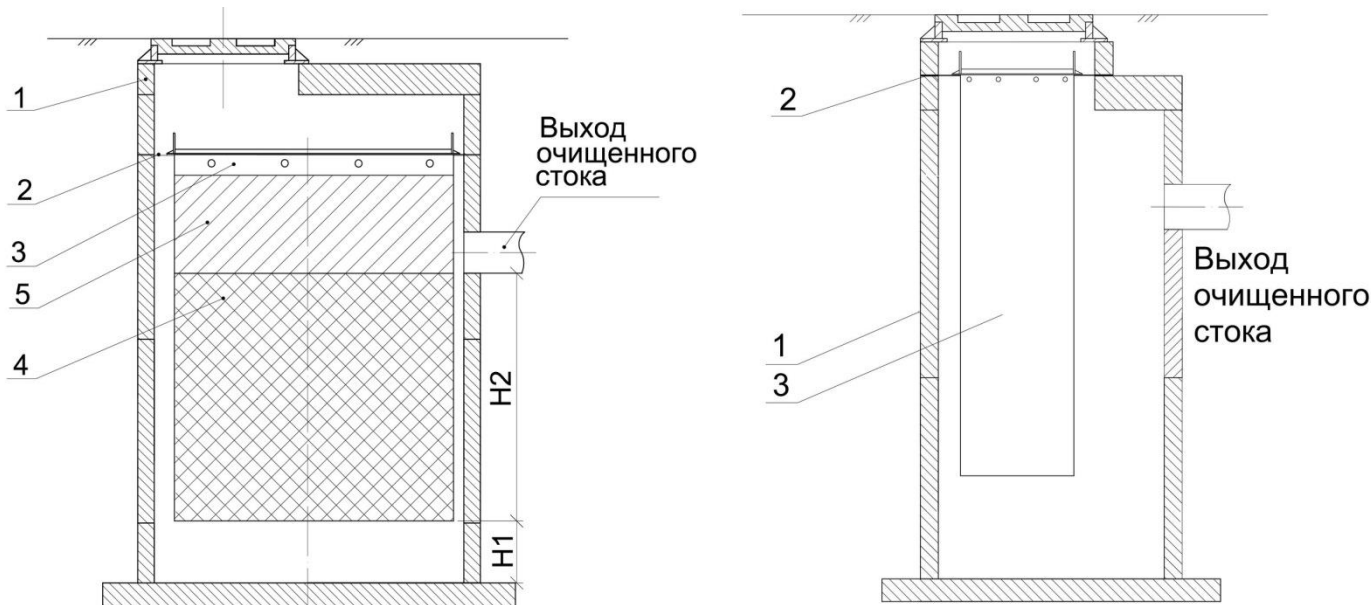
на стеновое кольцо, Рис. 2 – на бетонную плиту под люк.
